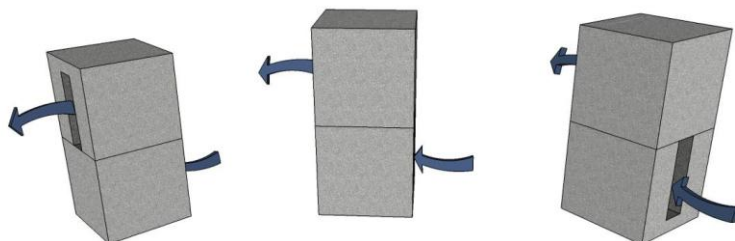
Croqui do elemento (ressonador) instalado como vazado
